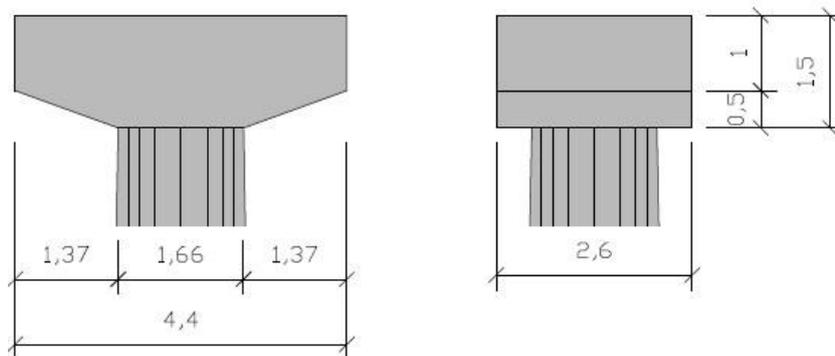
Detalle del cabezal de las pilas del Puente 3. Sección transversal (izqda.) y longitudinal (dcha.).
